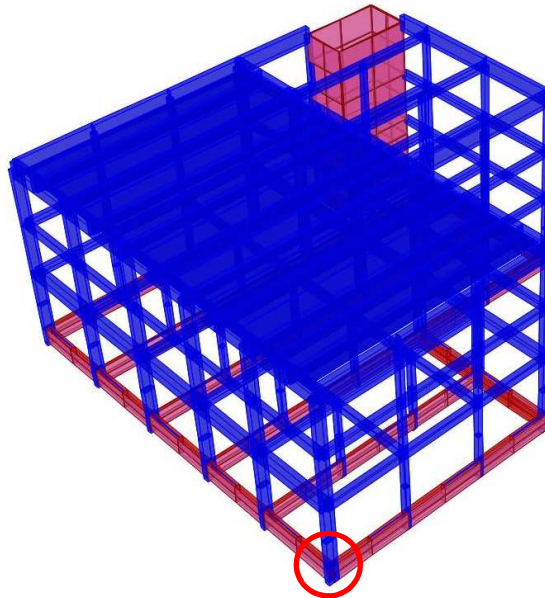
Localizzazione della sezione caratterizzata dal minor rapporto capacità/domanda rispetto alla sollecitazione di presso-flessione.
